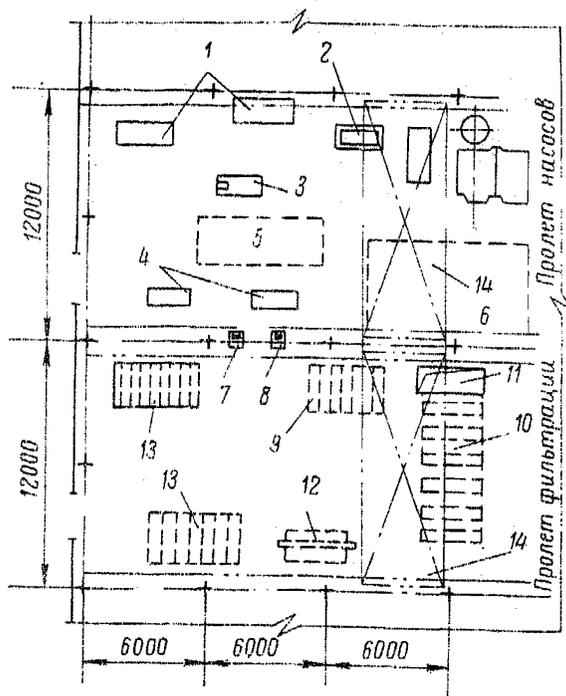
Ремонтно-монтажные площадки пролета насосов и пролета вакуум-фильтров. Площадь ремонтно-монтажной площадки насосов—184 м²; площадь, обслуживаемая краном,—120 м²; площадь ремонтно-монтажной площадки вакуум-фильтров—216 м²; площадь, обслуживаемая краном,—144 м².
